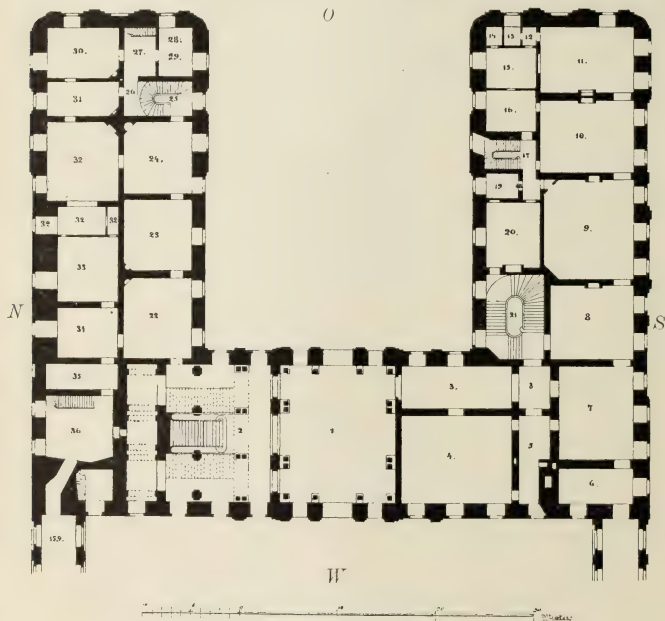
Schloss Brühl Unterer Grundriss
